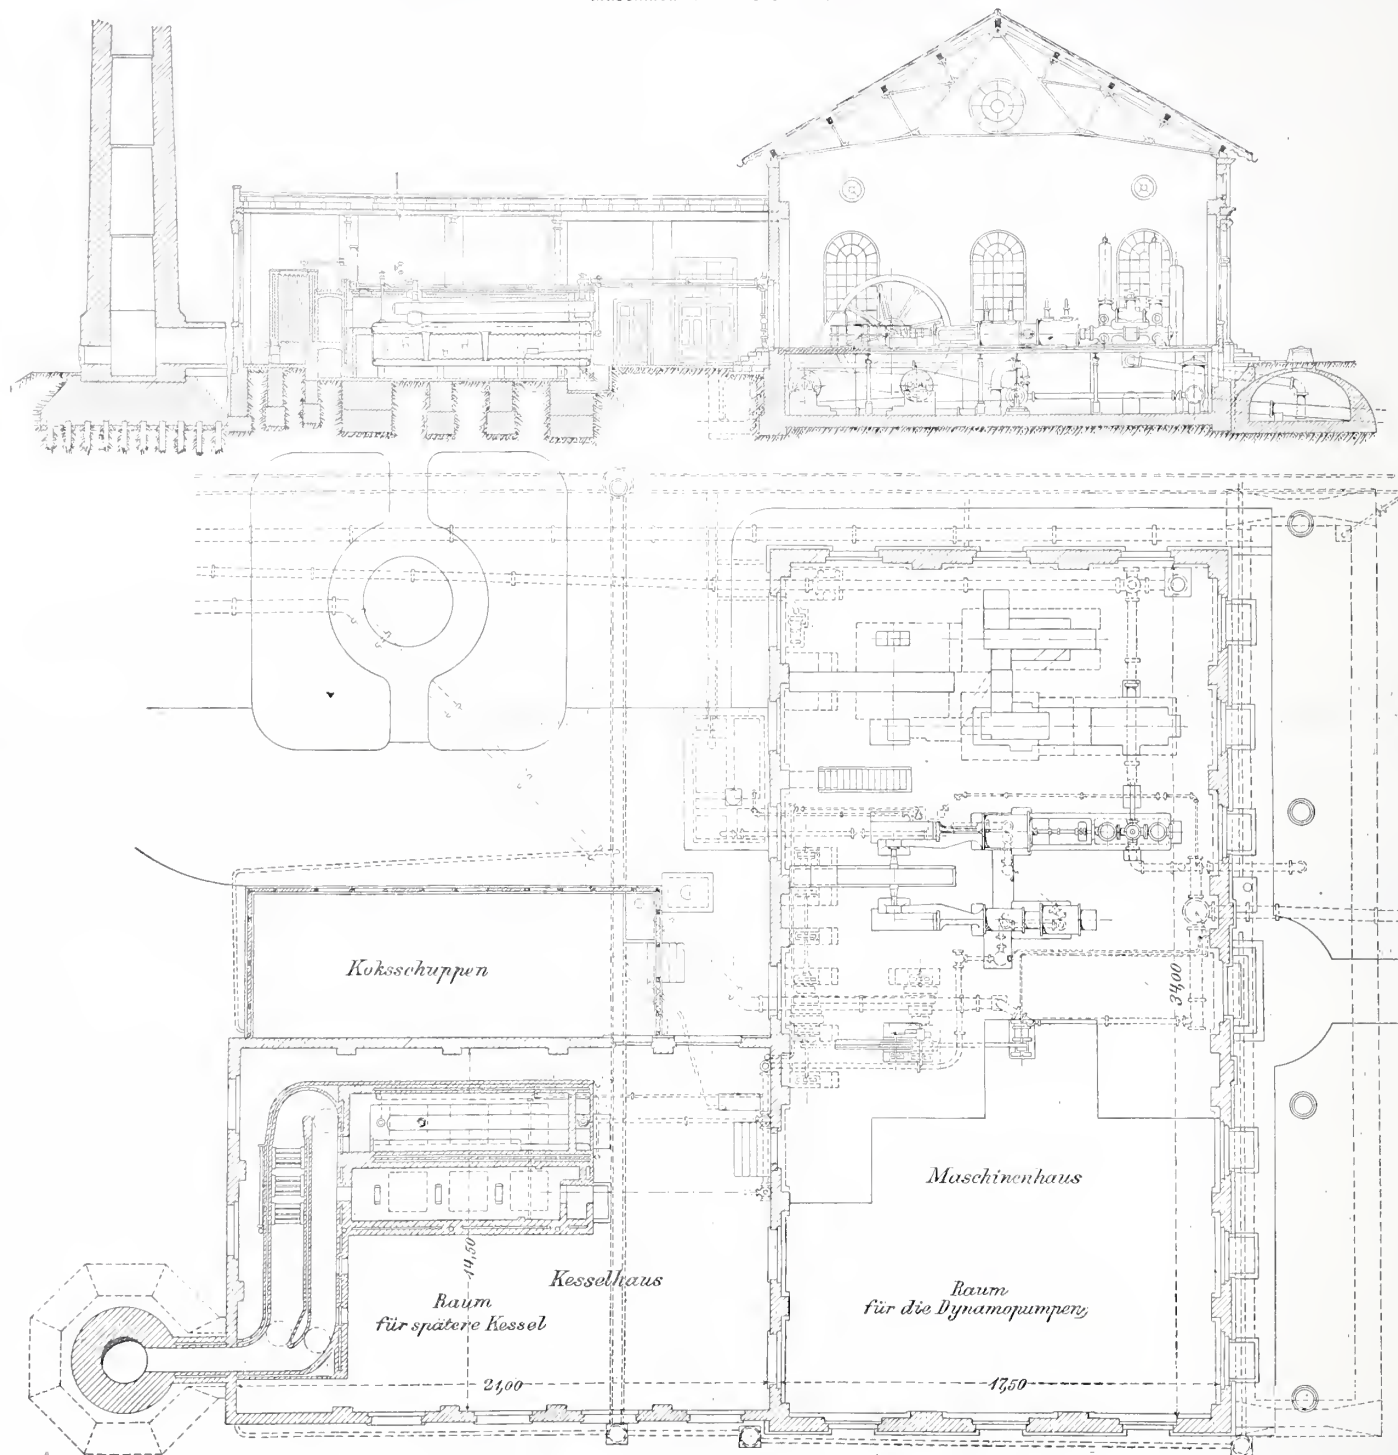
u. 2. Querschnitt und Grundriss; Masstab 1 : 300.
